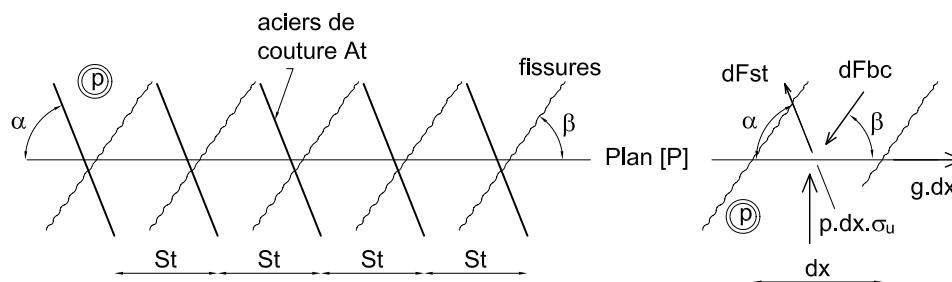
Equilibre d'une surface élémentaire du plan $[P]$.
